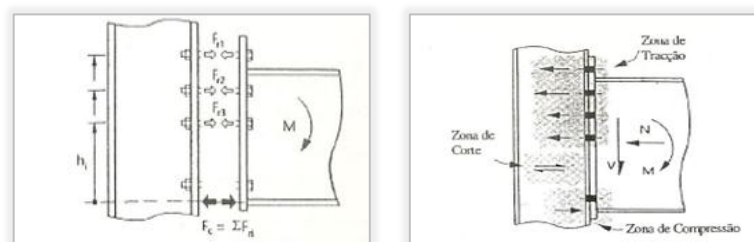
Ligação viga-pilar, zonas de esforços.
